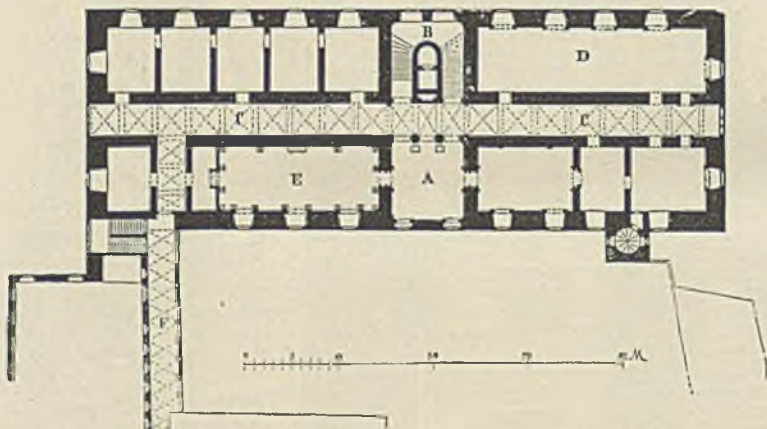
Grundriß des Obergeschosses im Schlosse zu Baden
